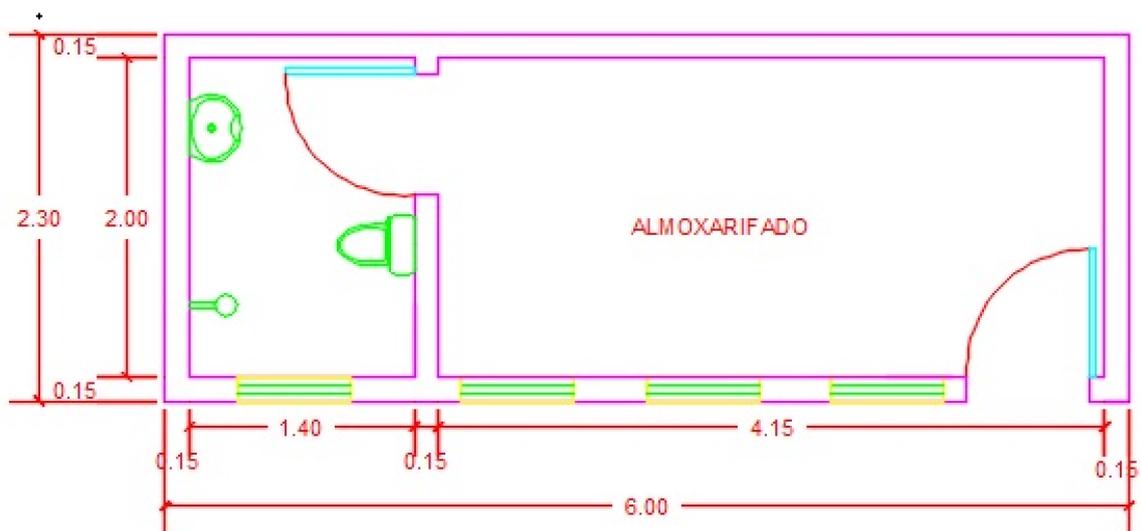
Planta baixa do almoxarifado. Fonte: Os autores.
